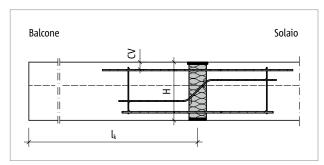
Schöck Isokorb® XT tipo BP: schema statico
